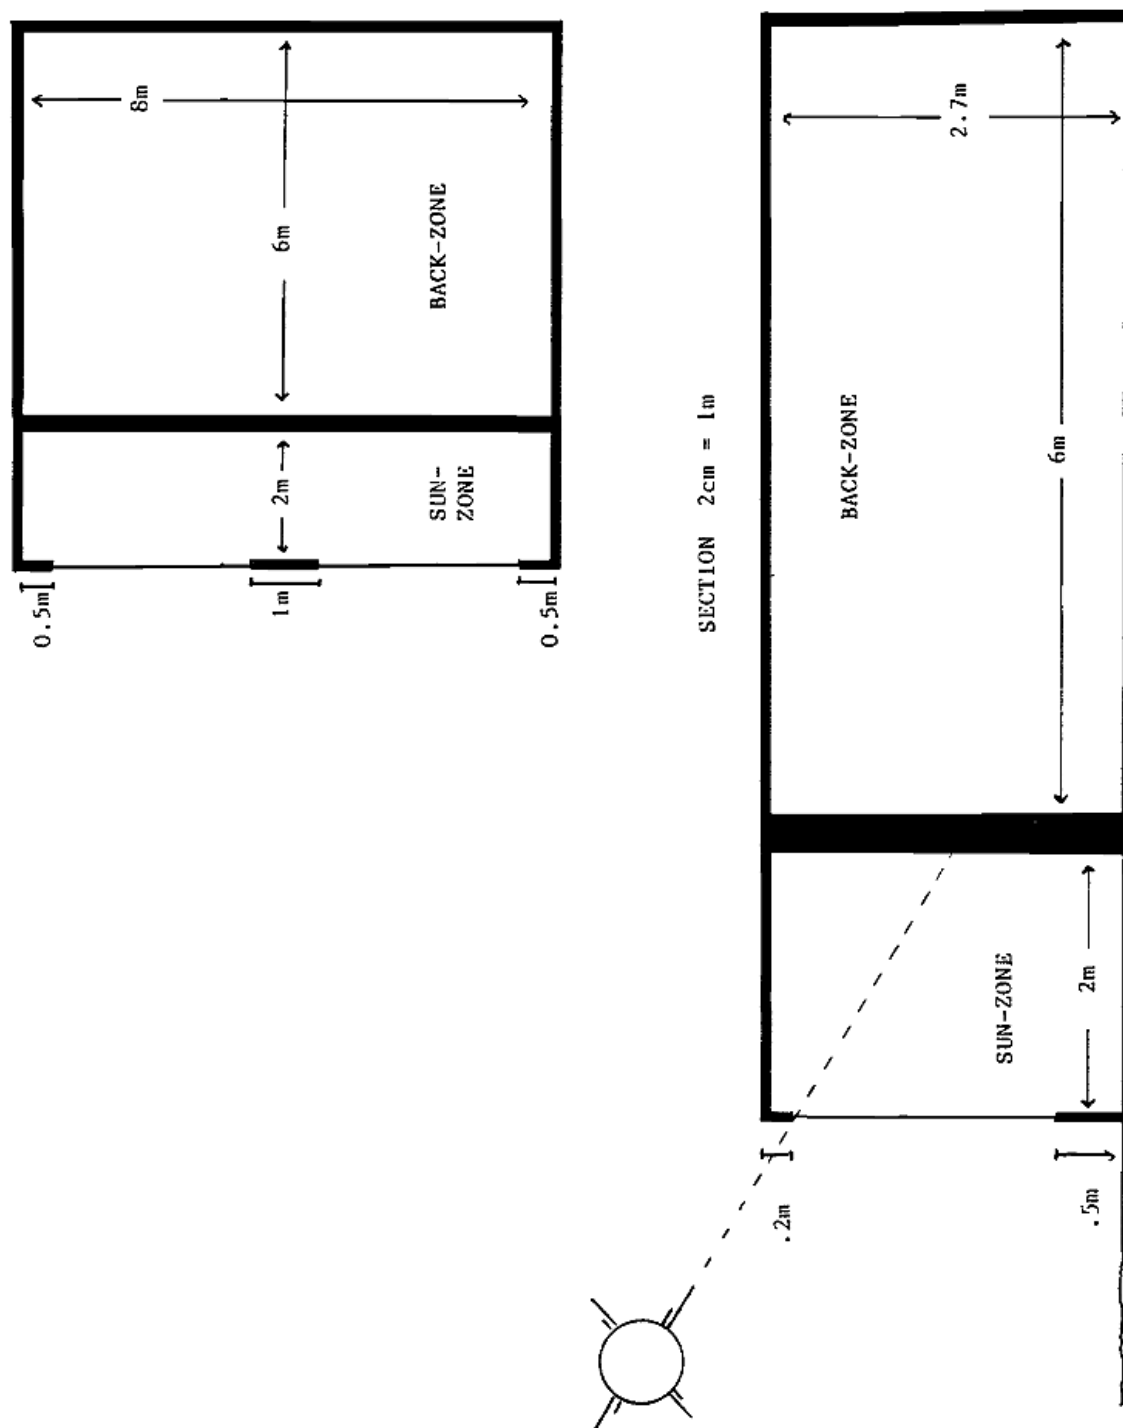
BESTEST: vista in pianta e in sezione della zona tampone soleggiata
